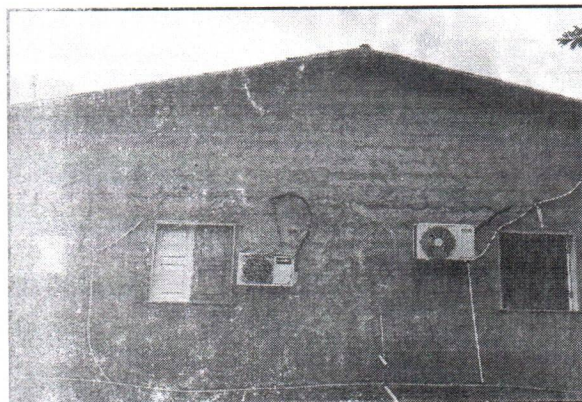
Vista Lateral do Imóvel, com destaque as esquadrias de madeira
